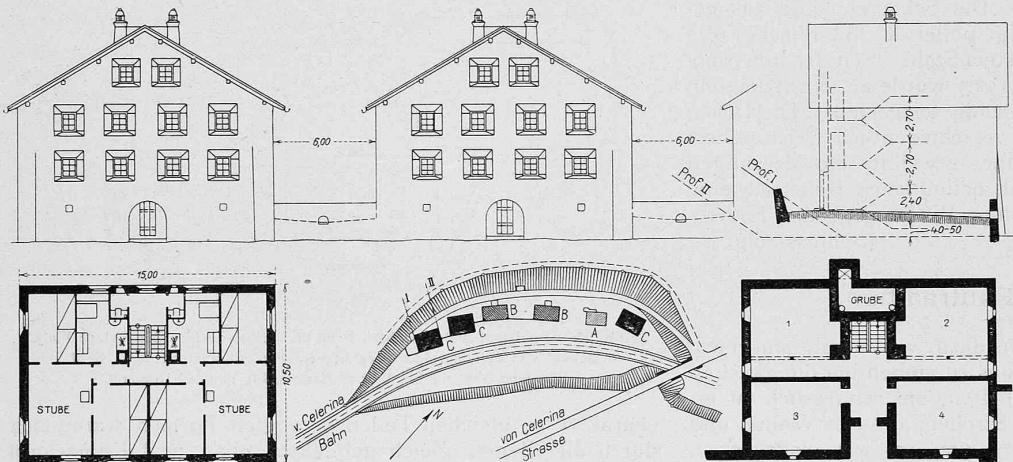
Lageplan 1:4000, Abb. 9 bis 11 Grundrisse, Fassaden und Profil 1:400 der Häusergruppe Arieffa (Samaden) der Rh. B.
